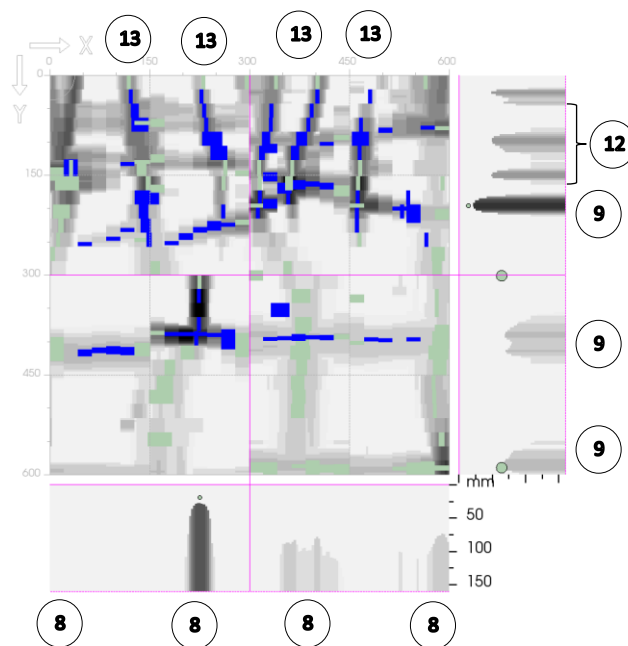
Ferrailage reconnu – Poutre Pt03
